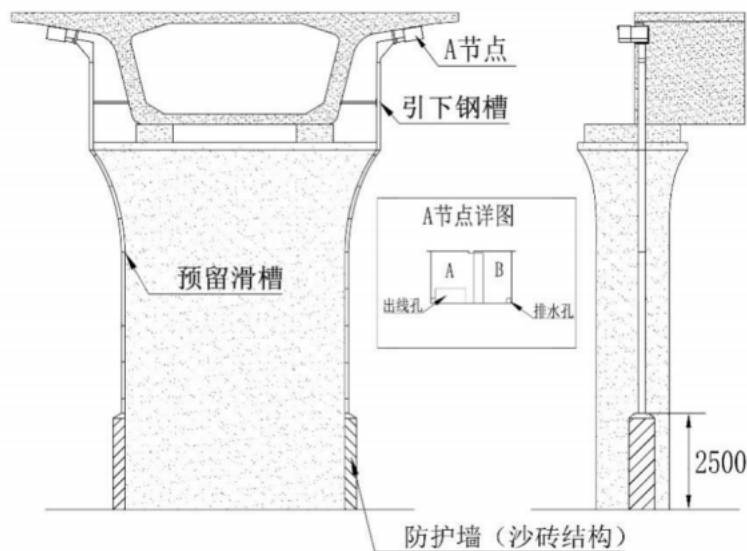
桥梁引下光电缆敷设钢槽防护示意图（单位:mm）
